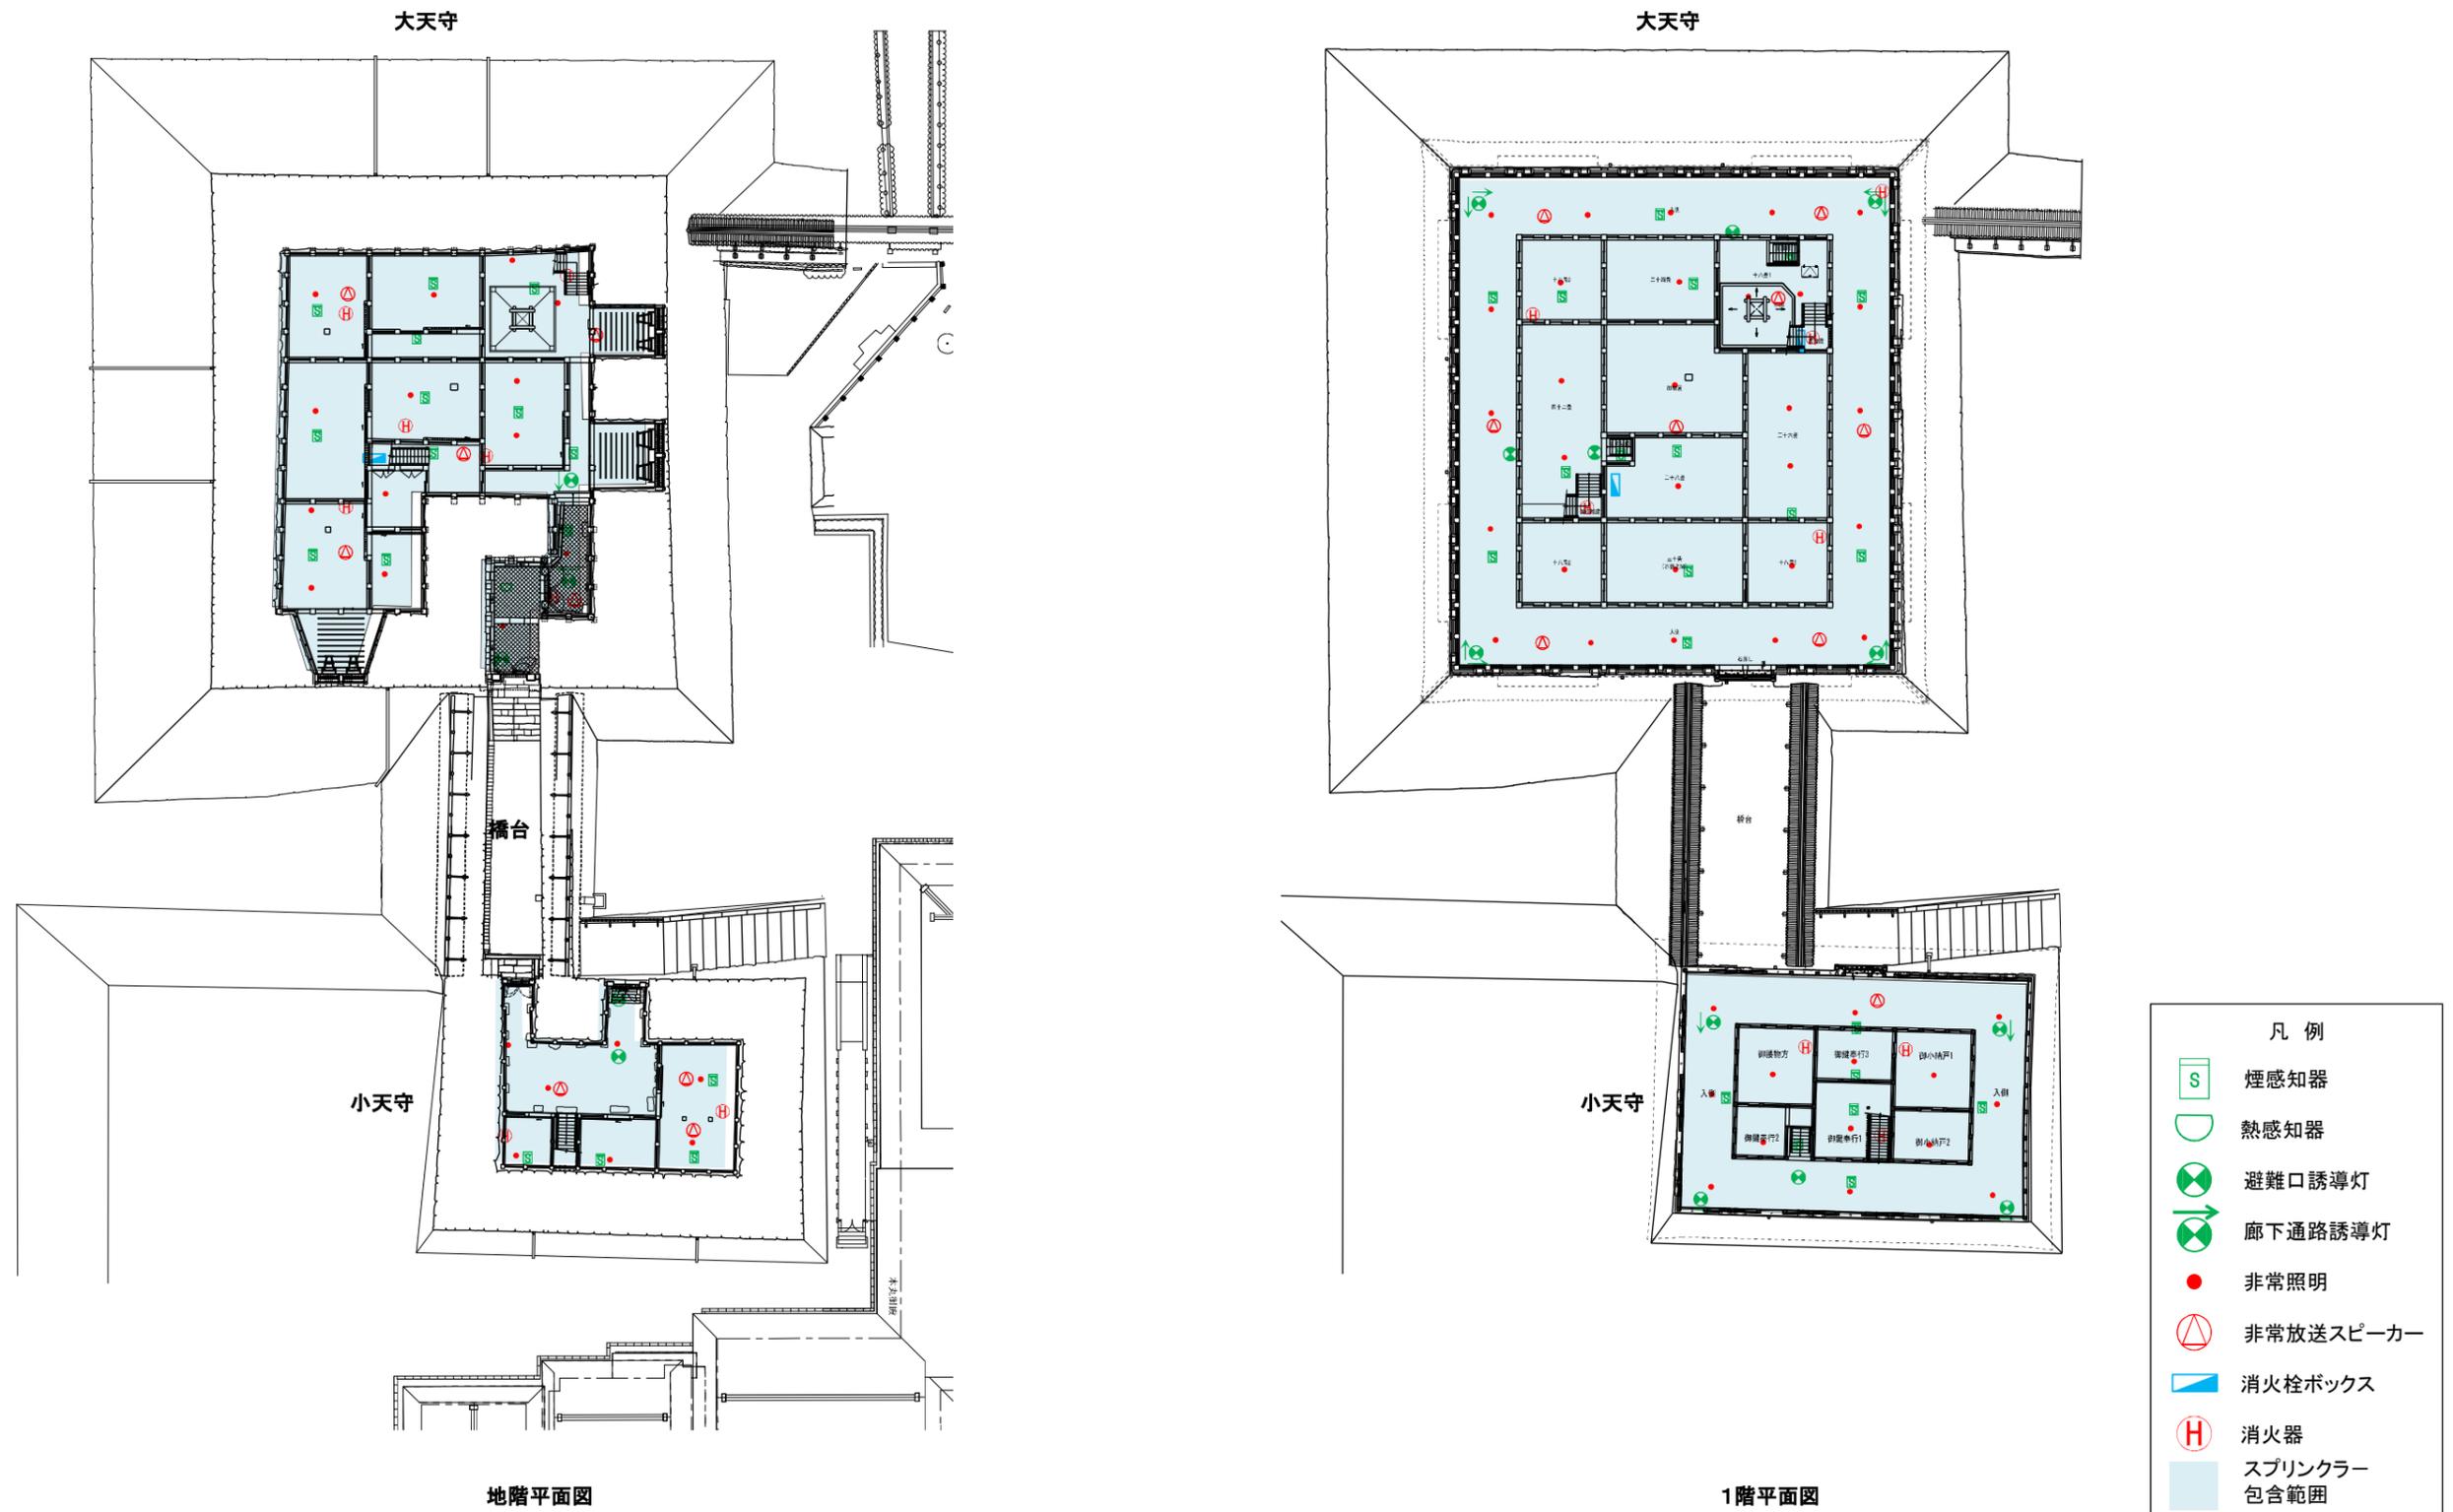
各階防災設備機器配置図 及び スプリンクラー包含範囲(1)
